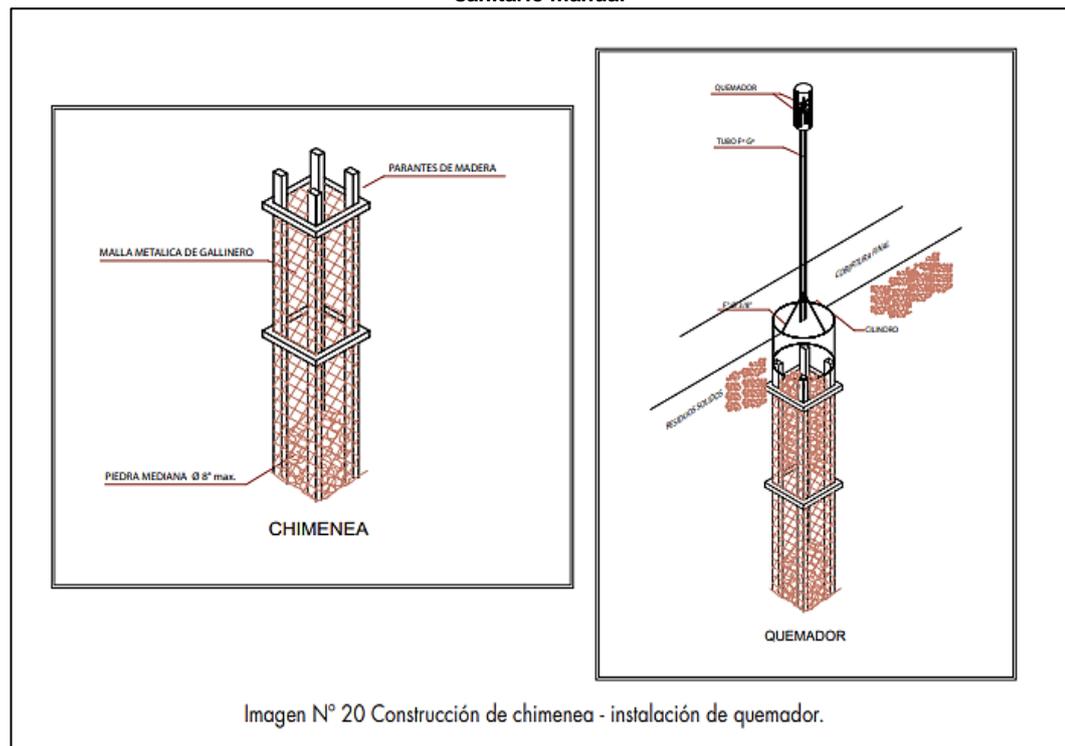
Construcción de chimenea - instalación de quemador.
